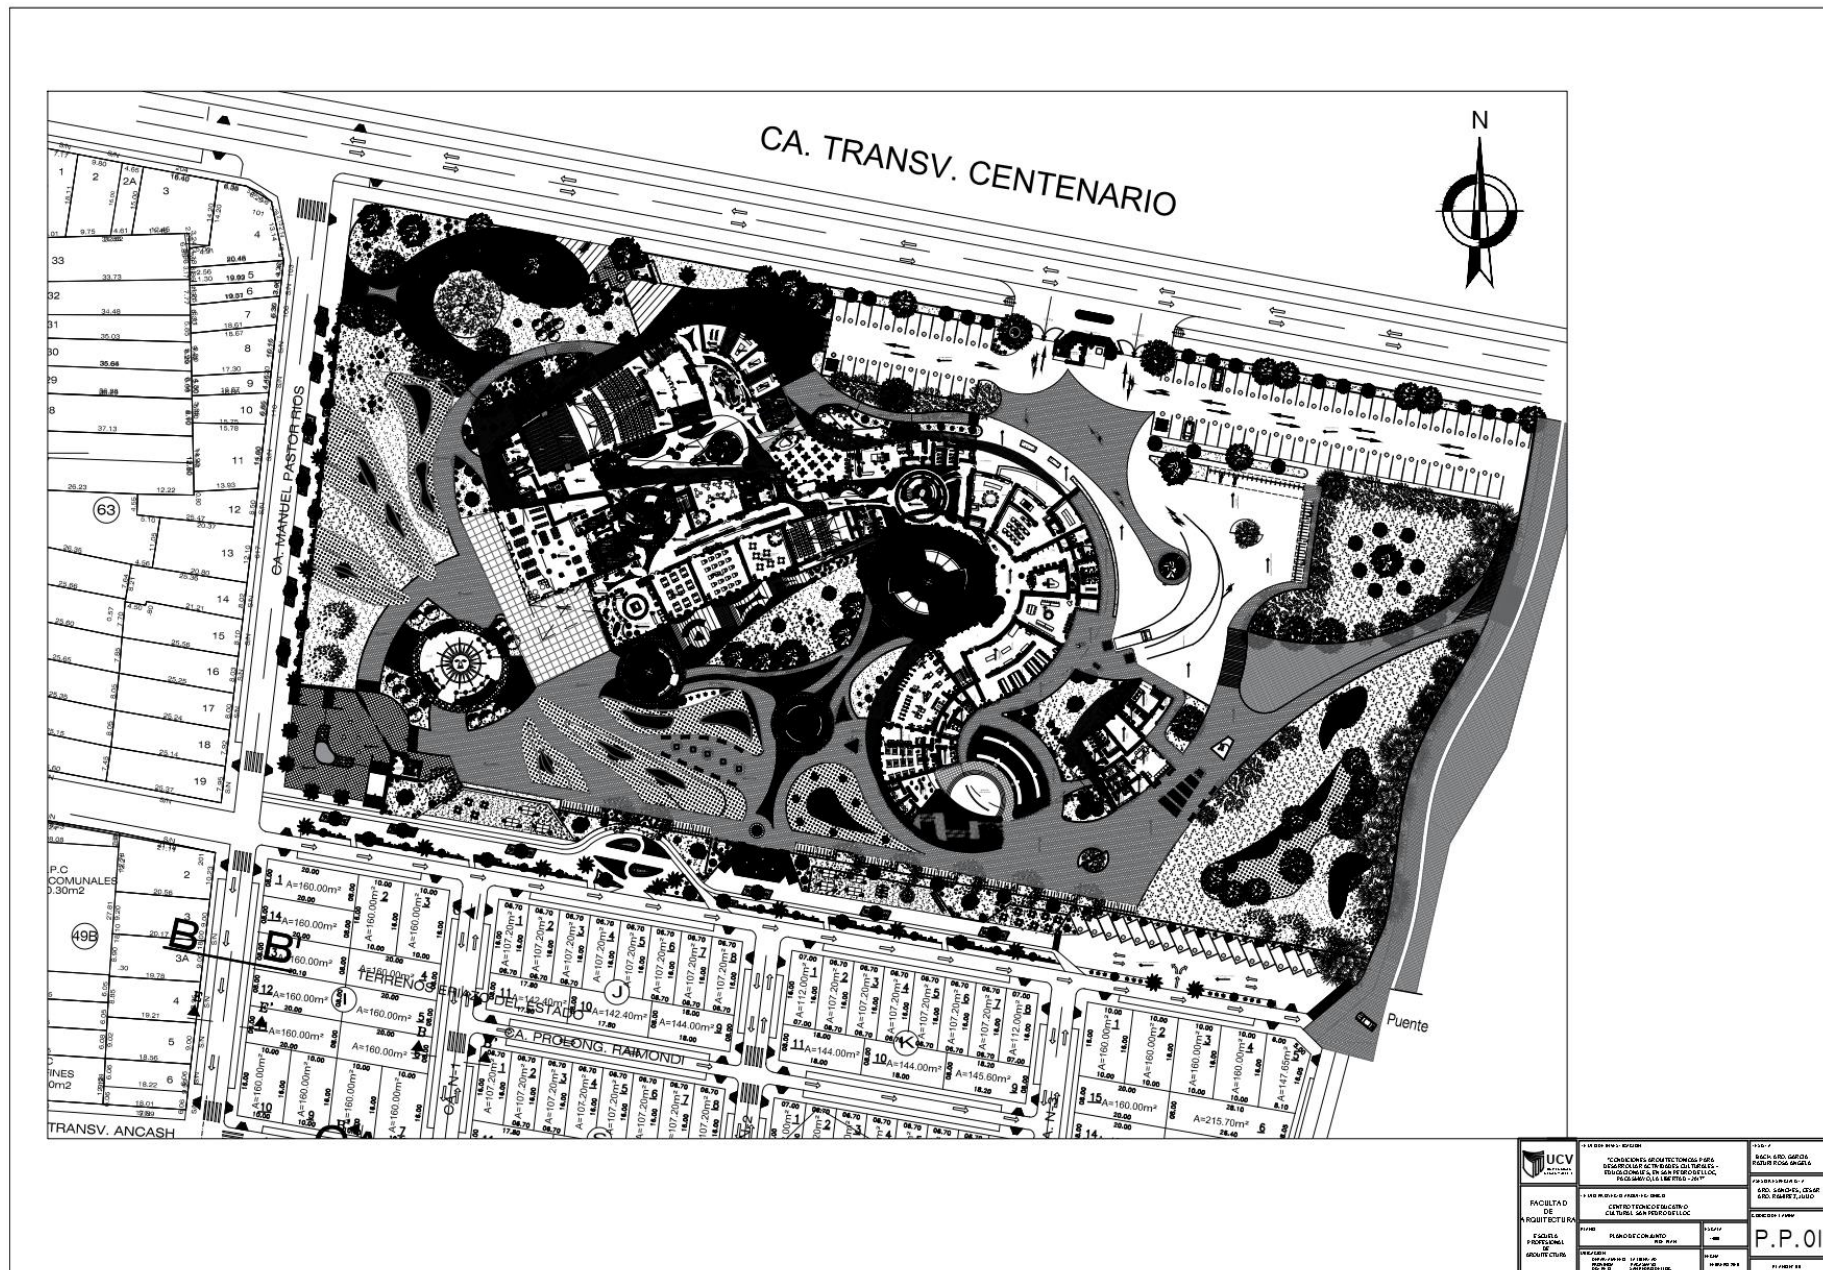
Plot Plan - Plano N° 05 - Lamina N°: P.P. - 01
